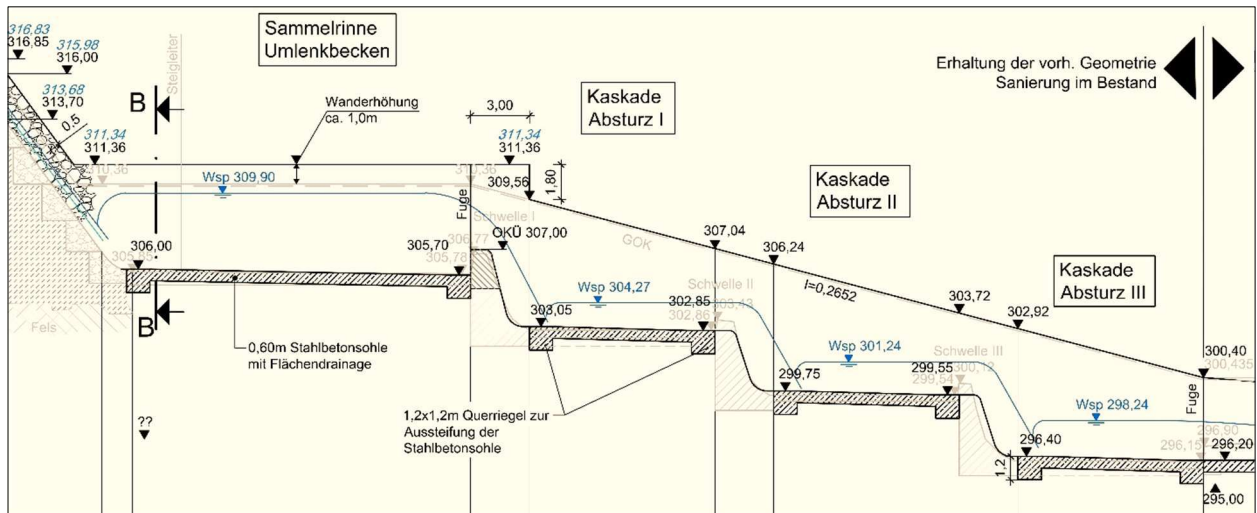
Variante A3/B1; HWE - oberer Abschnitt - Schnitt A; Ausschnitt aus Plan 433 HWE-Grundriss Schnitt A
